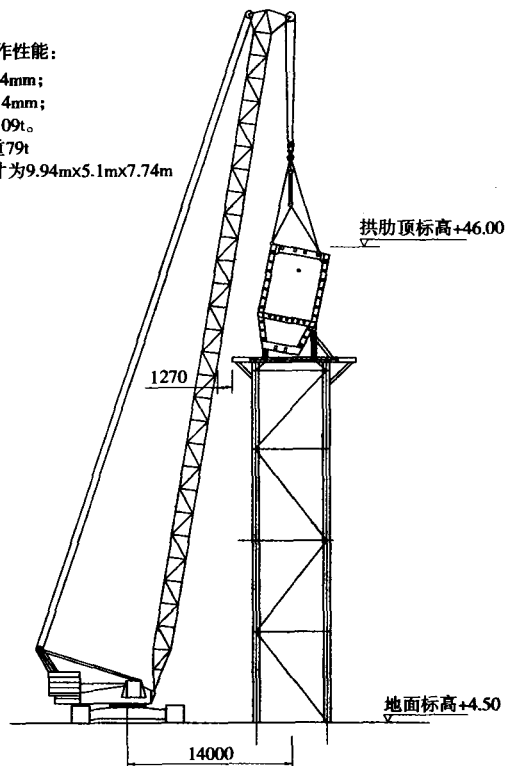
卢浦大桥大型履带安装拱肋 (标高单位: m) (尺寸单位: mm)
